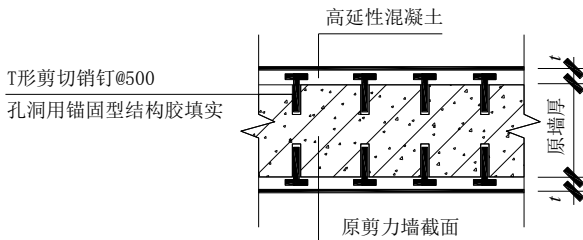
高延性混凝土面层加固钢筋混凝土剪力墙构造
